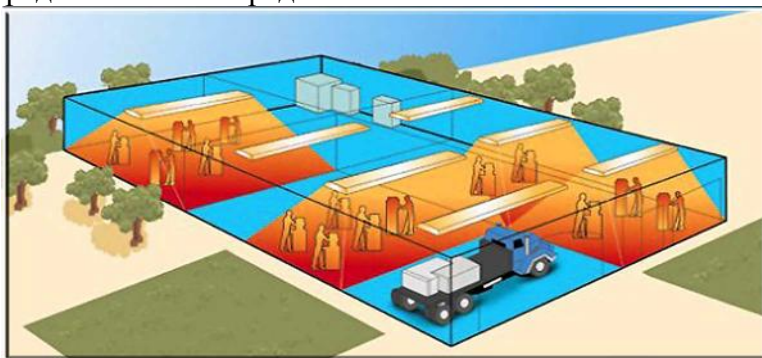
Зональный обогрев газовыми инфракрасными излучателями
